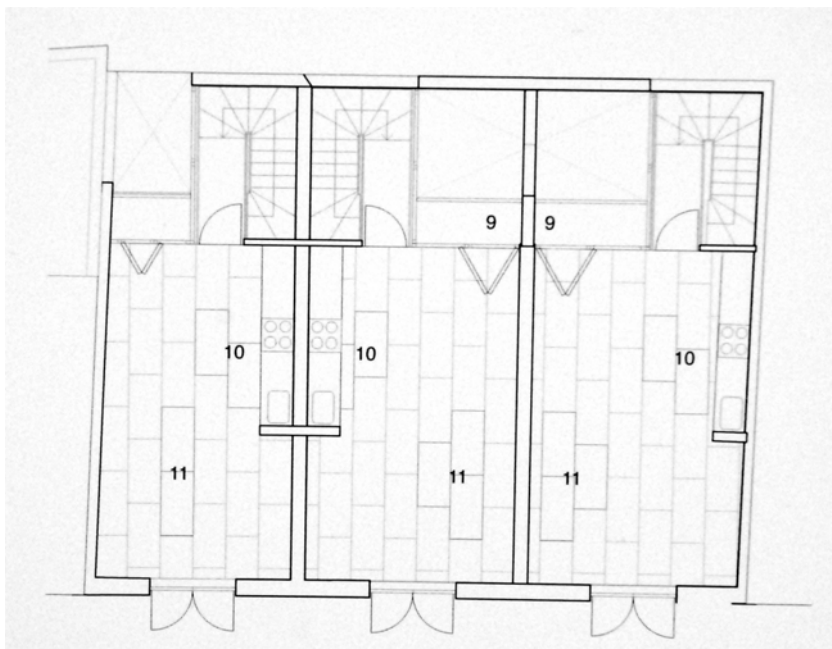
Artefact plan du deuxième étage (*T3_ple3*)⁵
